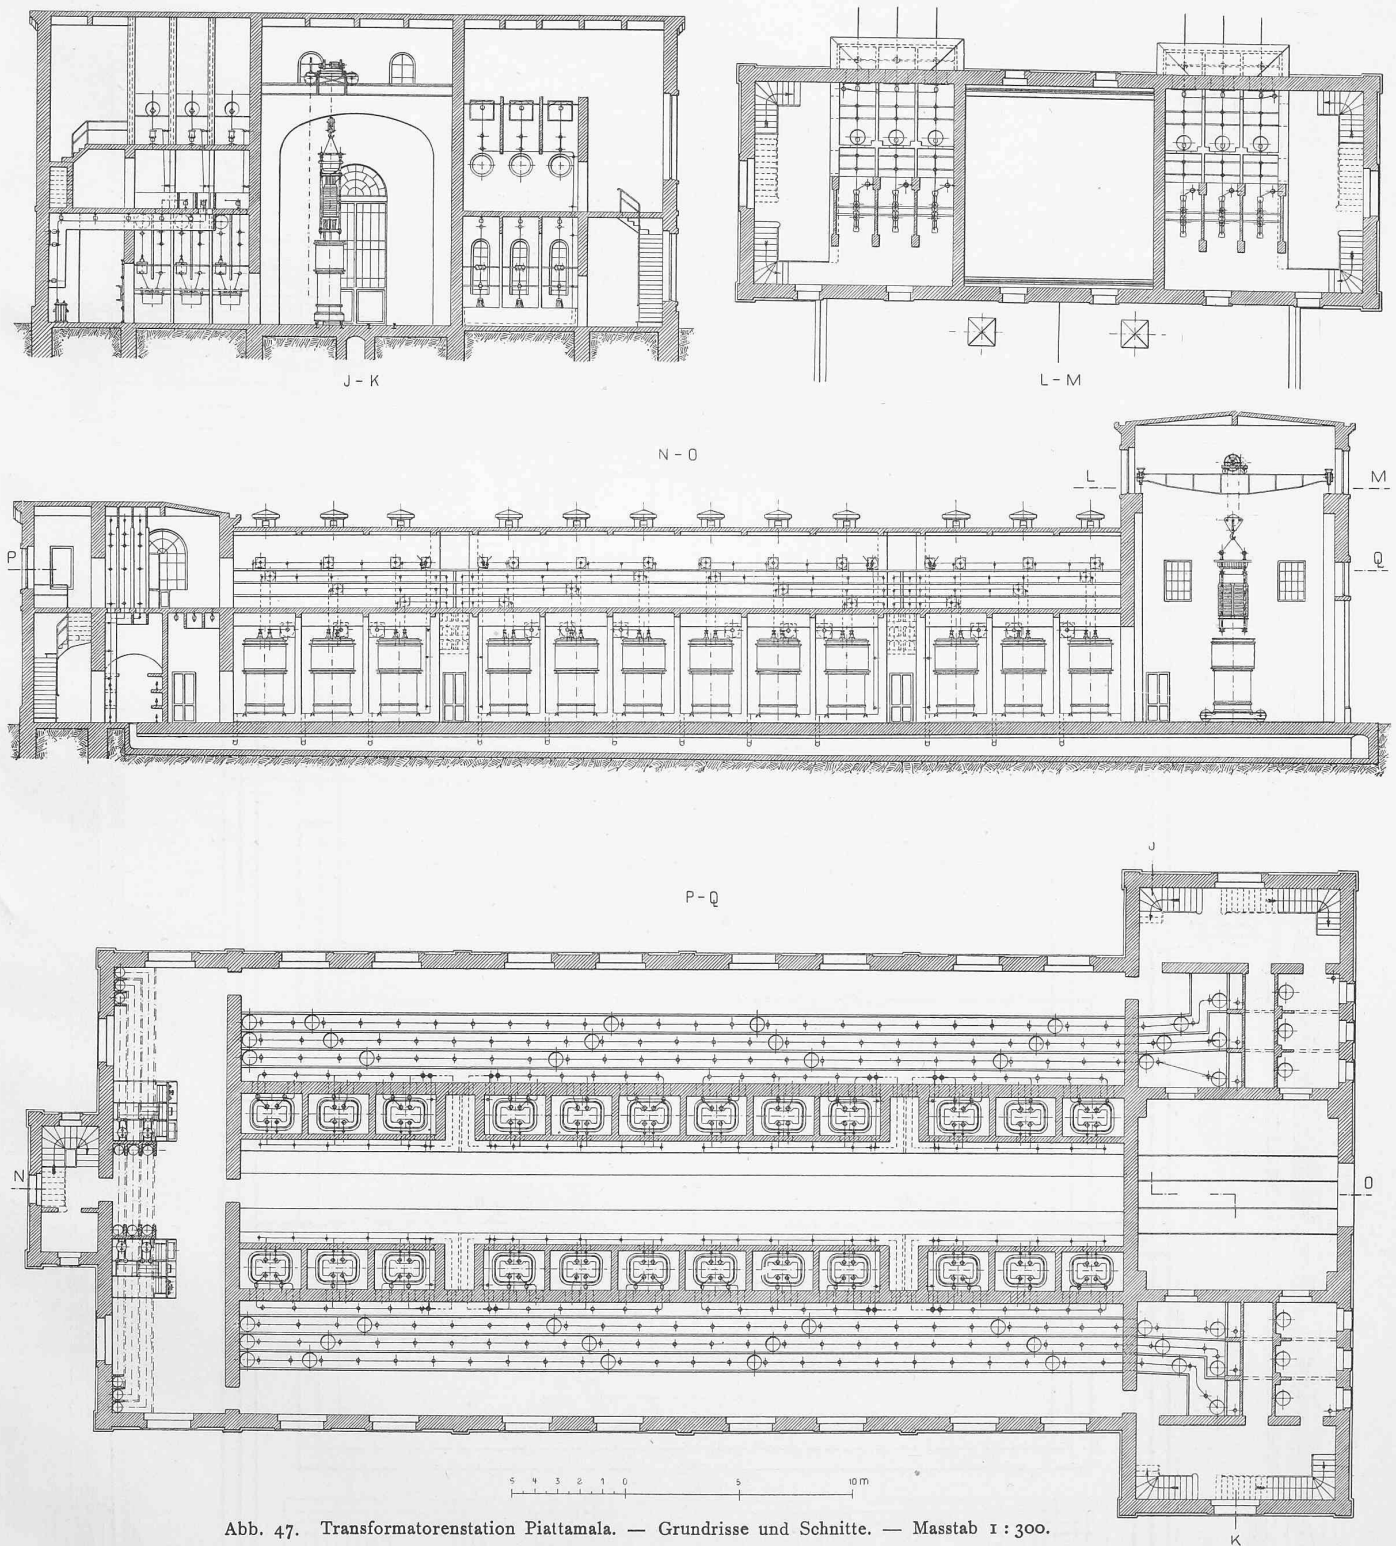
Transformatorstation Piattamala. — Grundrisse und Schnitte. — Masstab 1 : 300.
